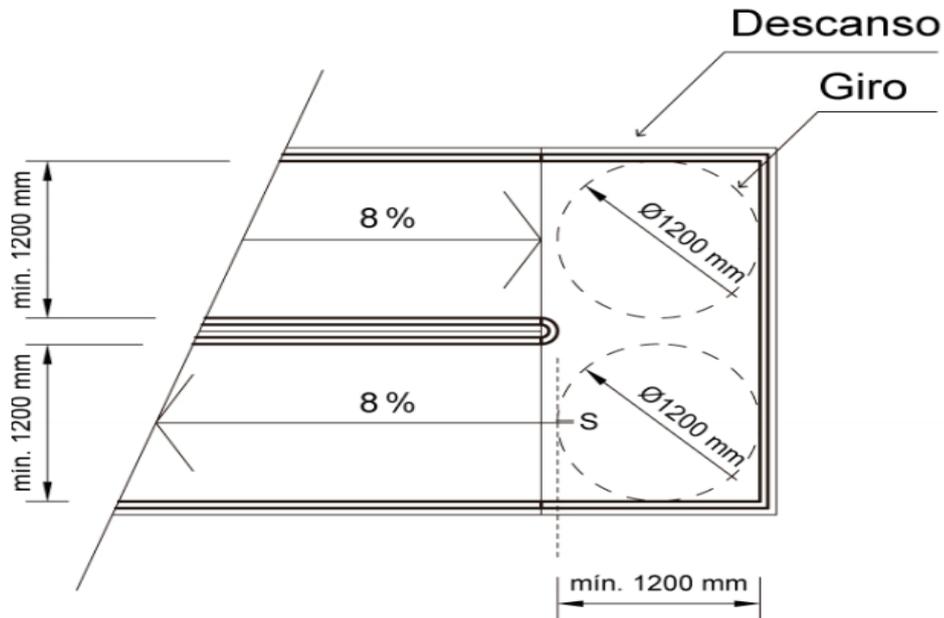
Modelo del rediseño estructural de las paradas con descanso.
